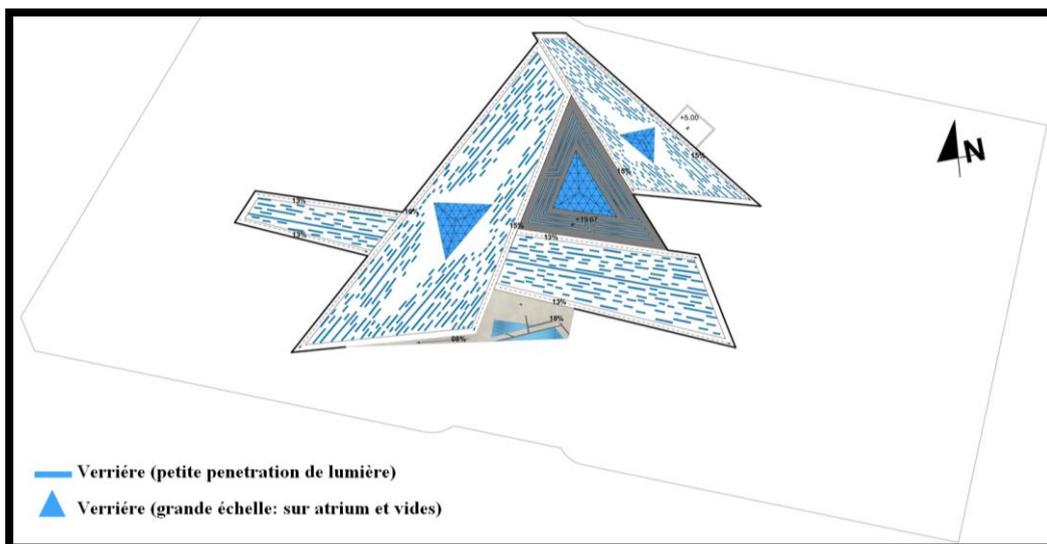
Utilisation de verrière dans notre projet (plan de toiture)
